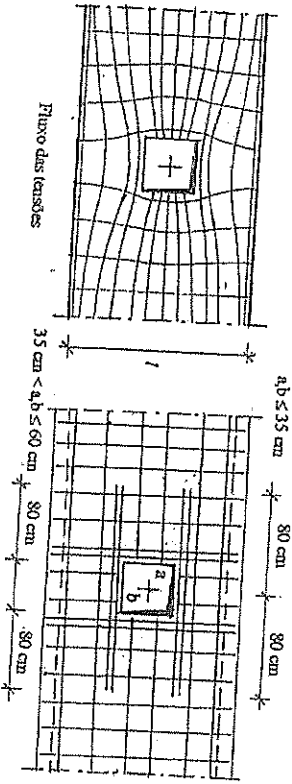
Reforço para abertura em lajes armadas em uma direção
